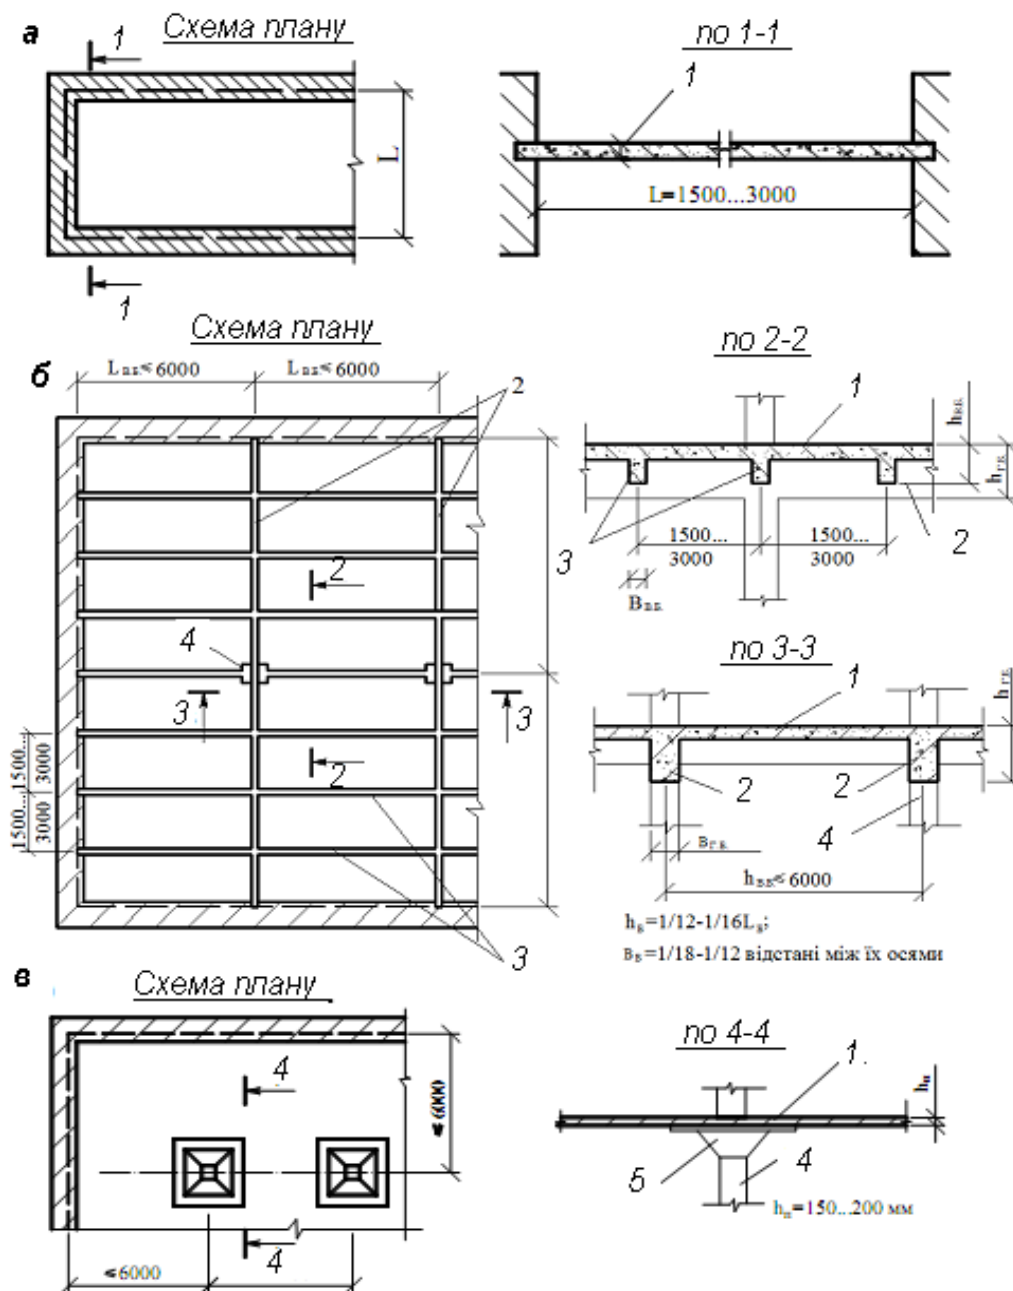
Монолітні залізобетонні перекриття: а – гладка однопролітна суцільна плита, б – ребристе перекриття, в – безбалкове перекриття; 1 – плита; 2 – головні балки; 3 – другорядні балки; 4 – колона; 5 – капітель
